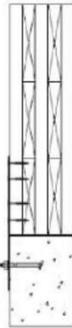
Assemblage métal-bois par plats métalliques sur support béton
